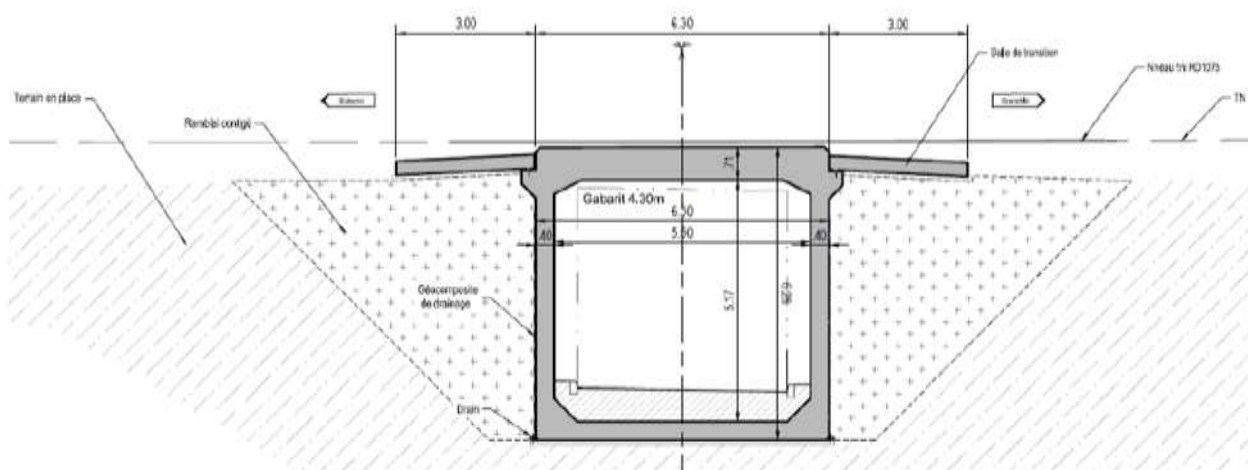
Coupe longitudinale du PI 224 - Solution Cadre
